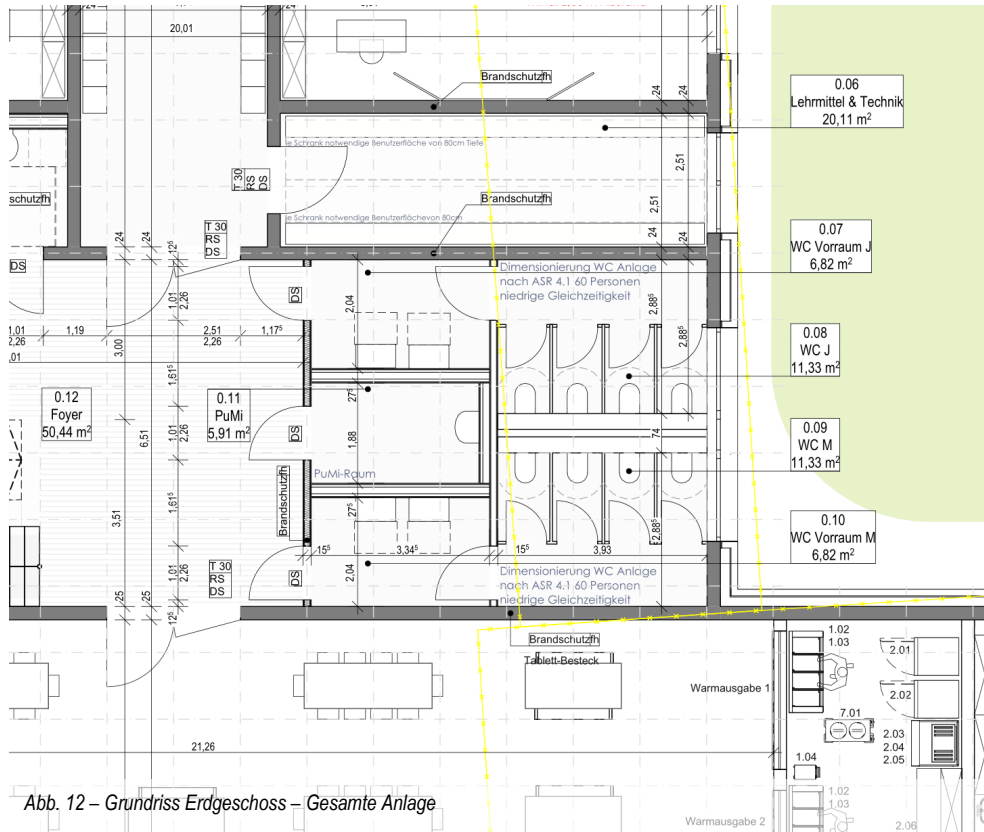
Grundriss Erdgeschoss – Gesamte Anlage
